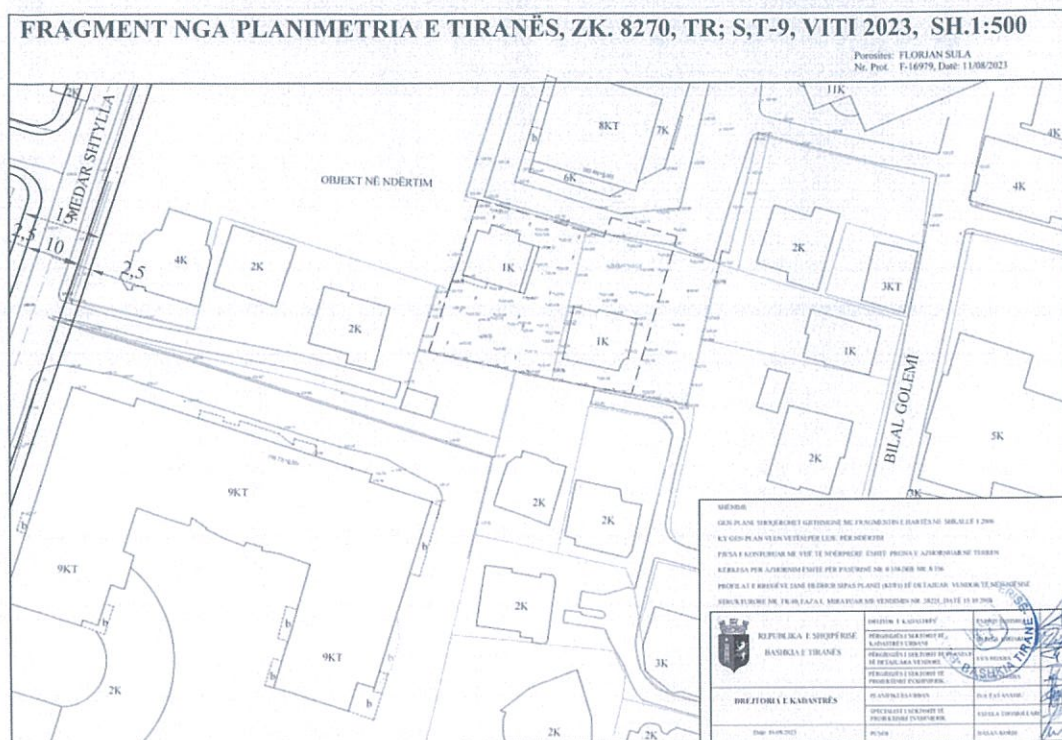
FRAGMENT NGA PLANIMETRIA E TIRANËS ZK. 8270, TR; S,T-9
